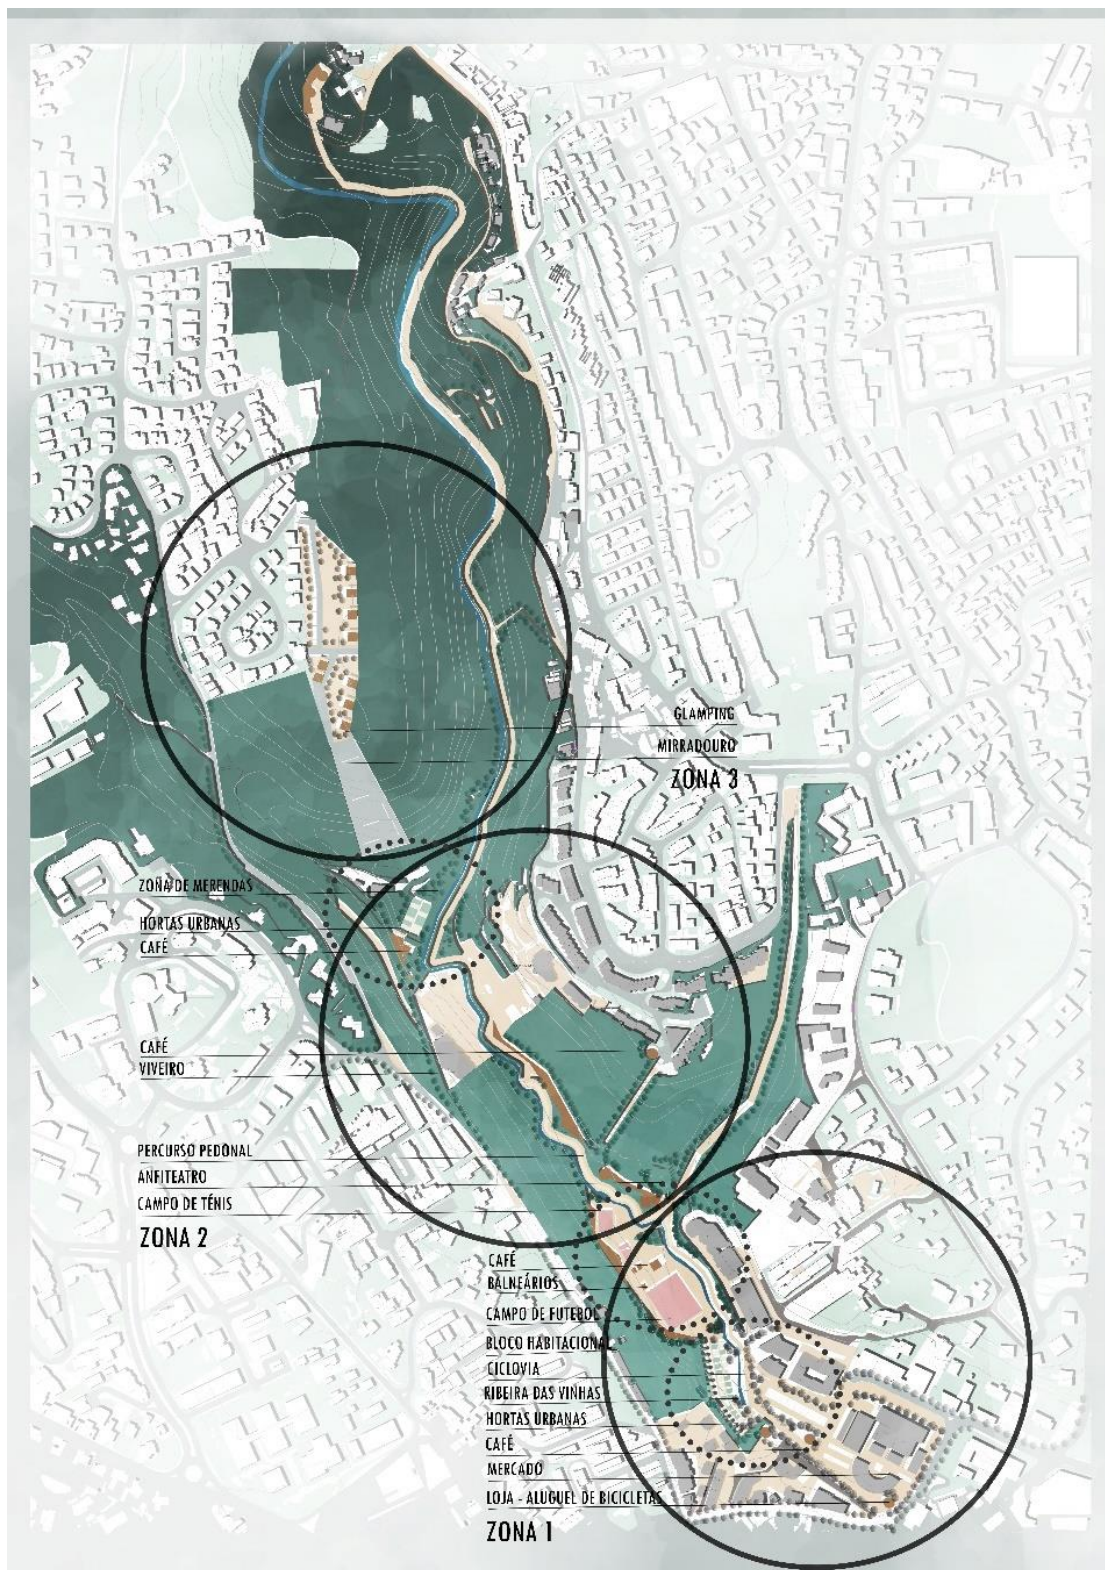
Planta 1.200 da área de intervenção e suas funções. Fonte: autora.
